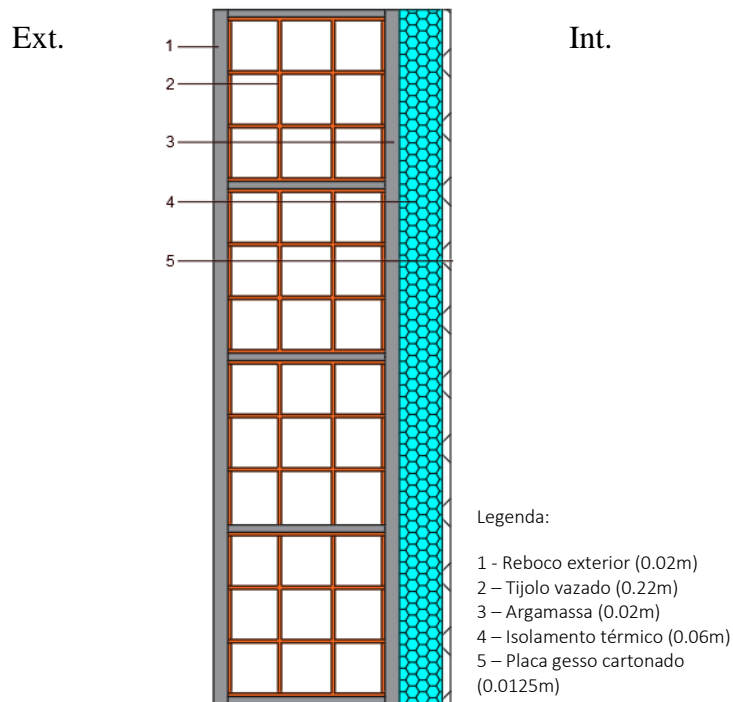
Pormenor construtivo referente à solução construtiva isolamento pelo interior com contra fachada em gesso acartonado
